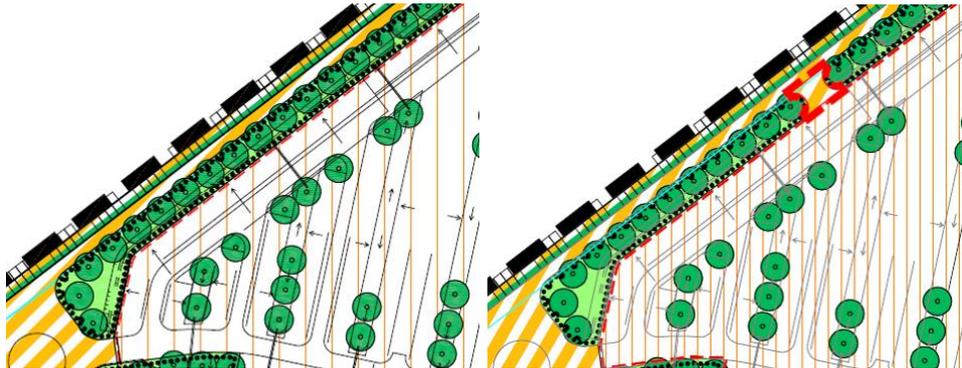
Änderungsbereich Zufahrt SO 1a
